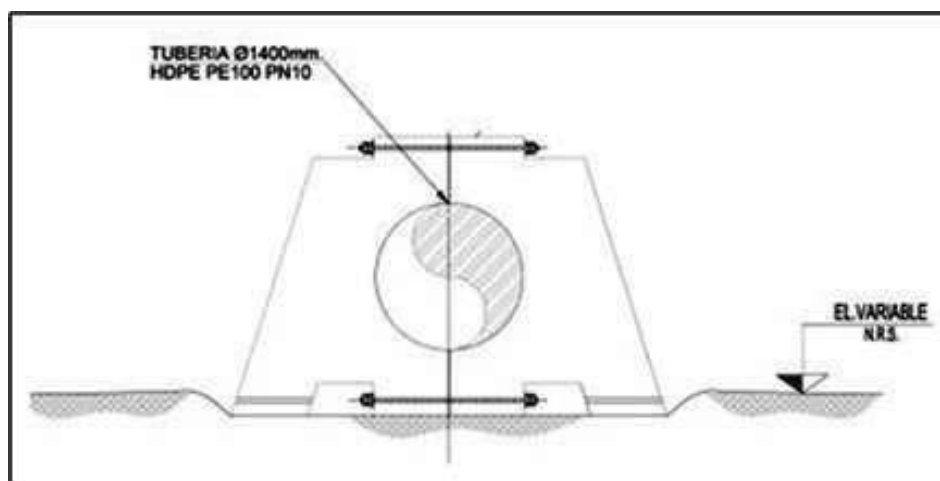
Lastre Tipo L3 para Tubería Descarga
